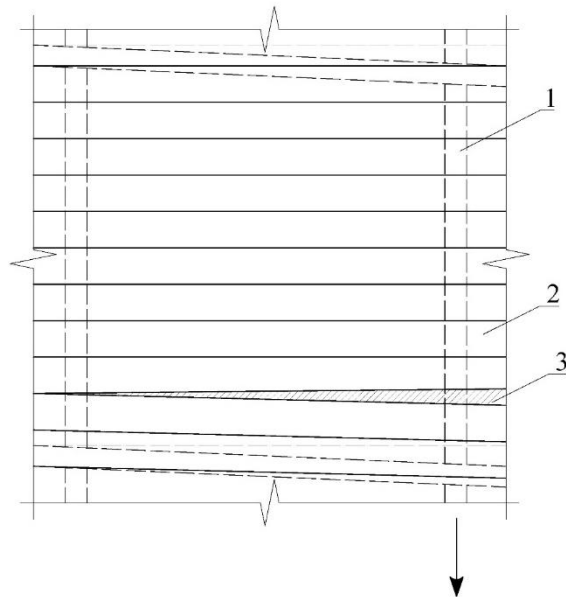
Принципиальная схема дефекта - осадка элементов каркасных стен деревянного здания с образованием перекосов и щелей: 1 – стойка каркаса; 2 – элемент обшивки стены (доска); 3 – щель между элементами обшивки стены; b – ширина щели между элементами стены, см.
